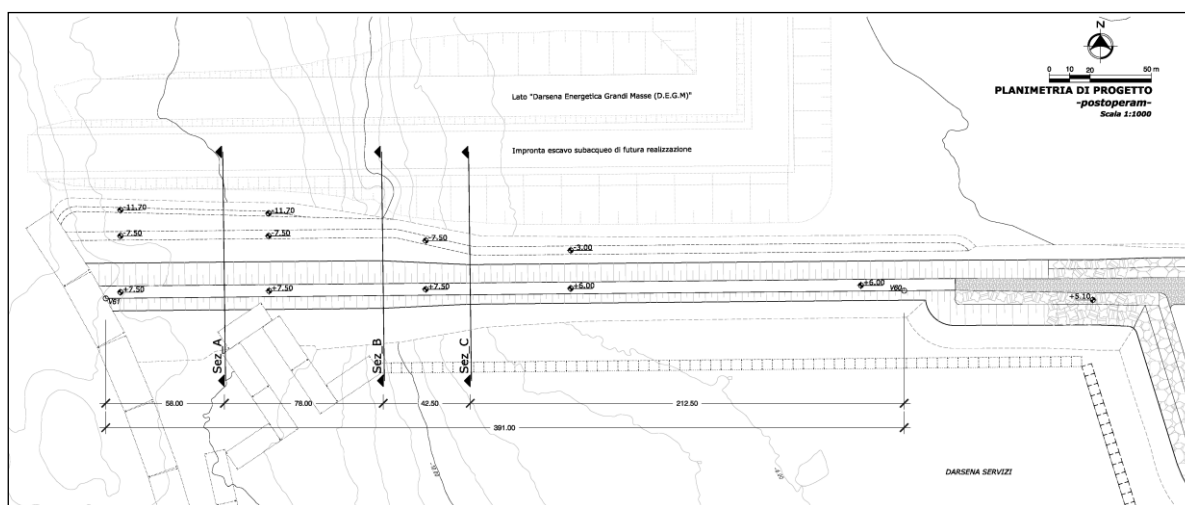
Stralcio planimetrico della Diga a Gettata Nord come da progetto esecutivo
